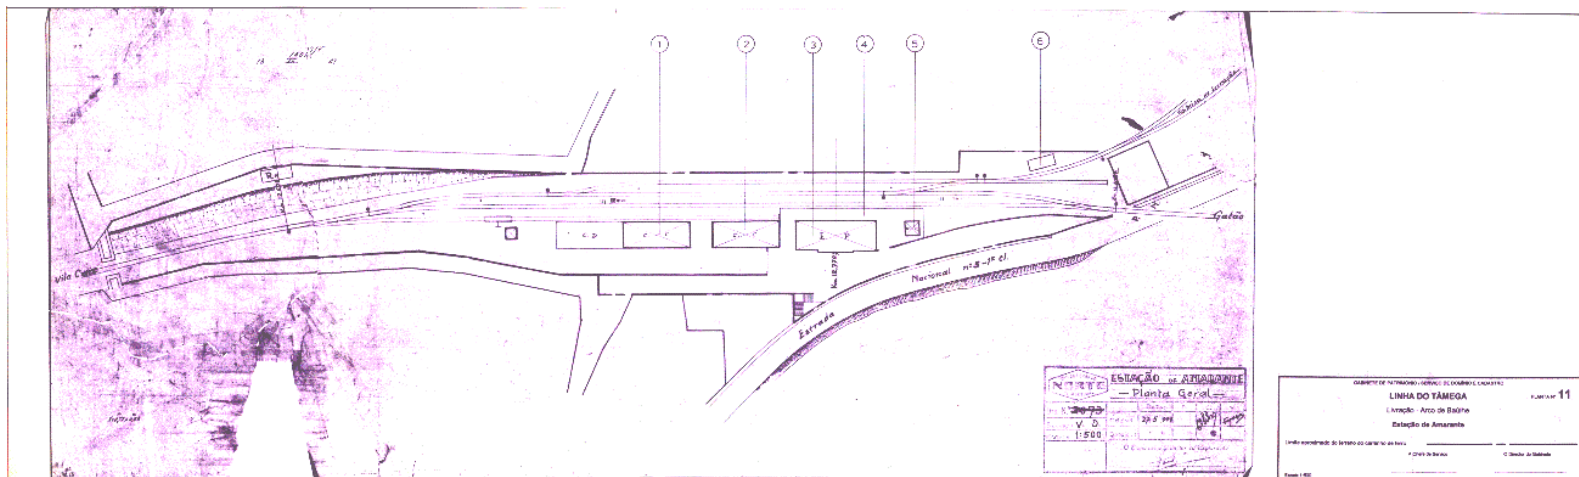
| Linha do Tâmega, planta da Estação Ferroviária de Amarante (S/escala)
